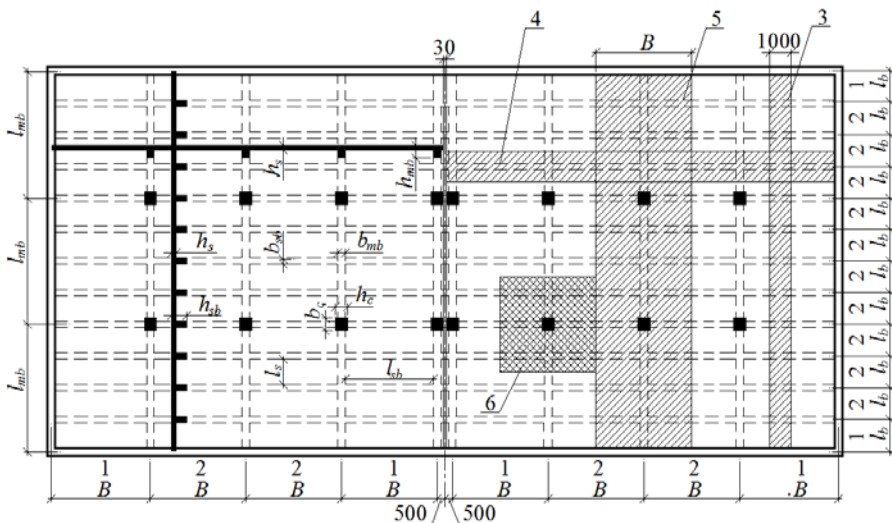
Расчетная схема ребристого перекрытия с балочными плитами:
